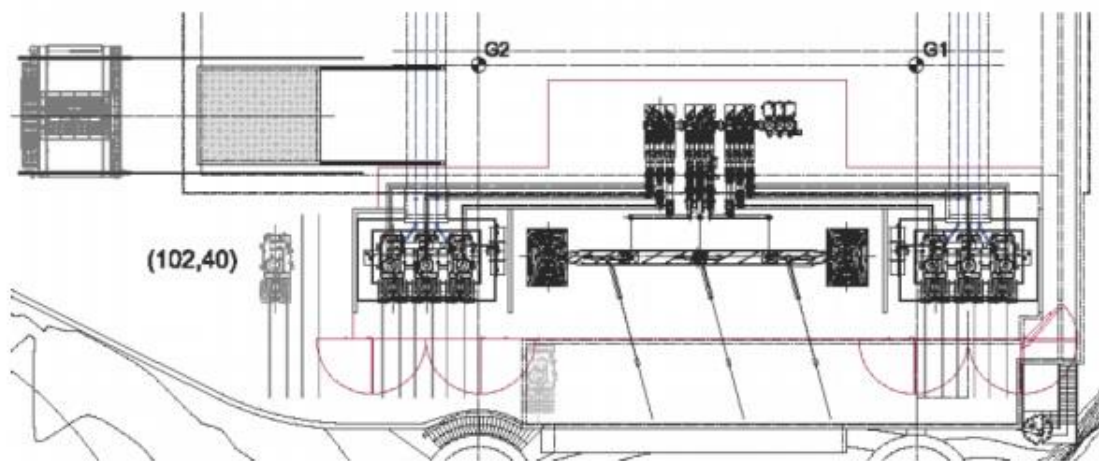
Planta Geral da subestação do AHFT [48].
